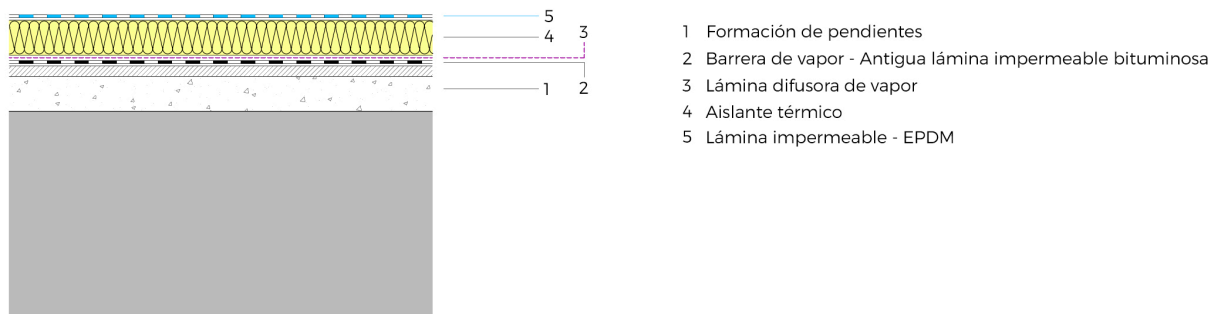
Barrera de vapor mediante reutilización de láminas impermeables bituminosas existentes en una cubierta convencional.
